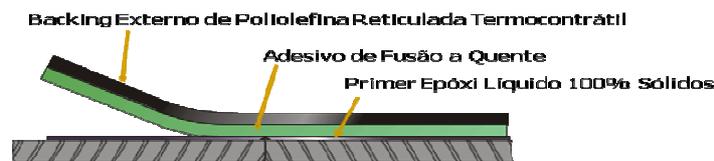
Sistema Tripla Camada de Revestimento para Juntas de Campo Soldadas
